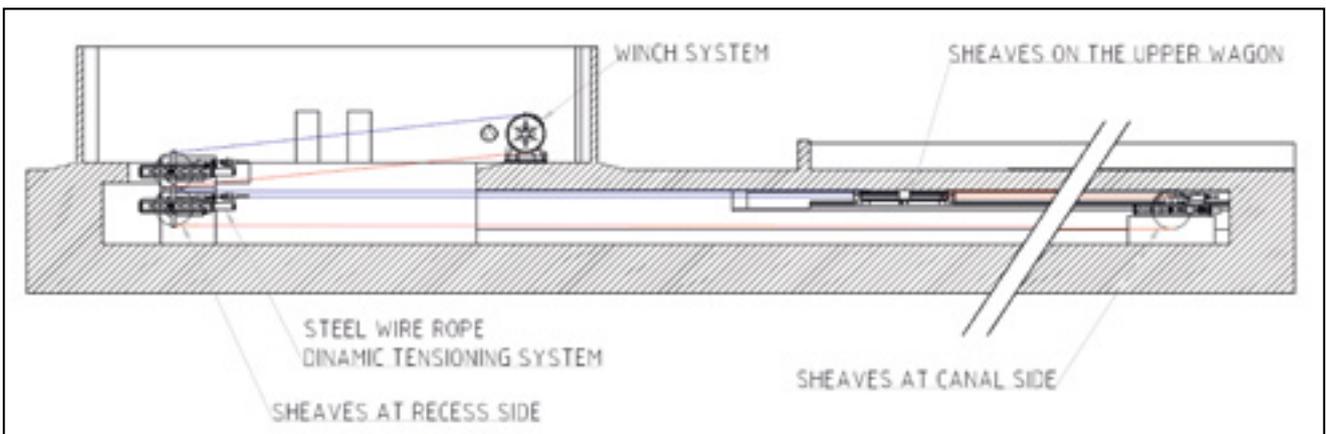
Perfil transversal con el esquema general de los cables de tracción de la compuerta.
